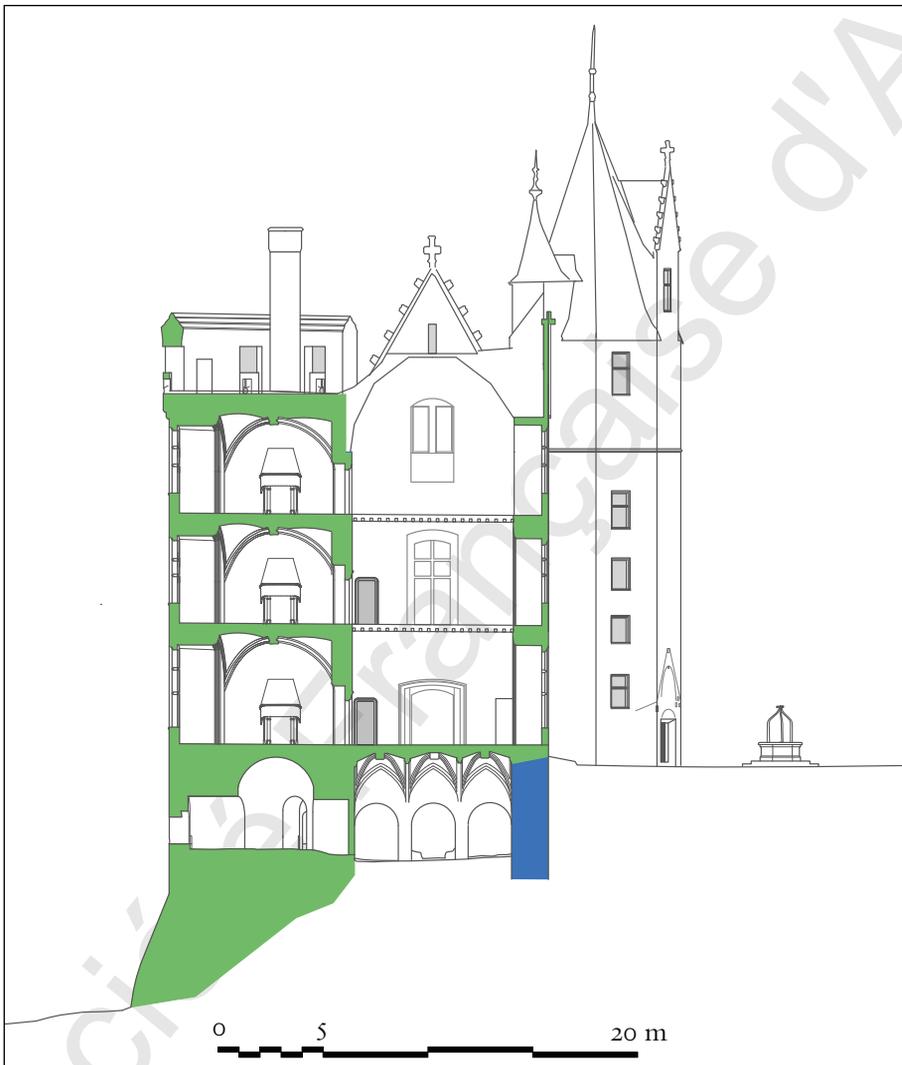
Montreuil-Bellay, château, coupe prise du nord (à gauche) vers le sud (à droite), du logis neuf, au travers de la tour e3 et de la grande salle. On voit, à droite, la grande vis avec sa porte de service, et le puits restitué au XX^e siècle (dessin J. Mesqui 2022).
